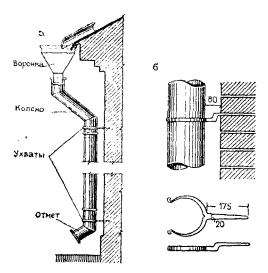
Водосточная труба а — общий вид; б — крепление к стене
